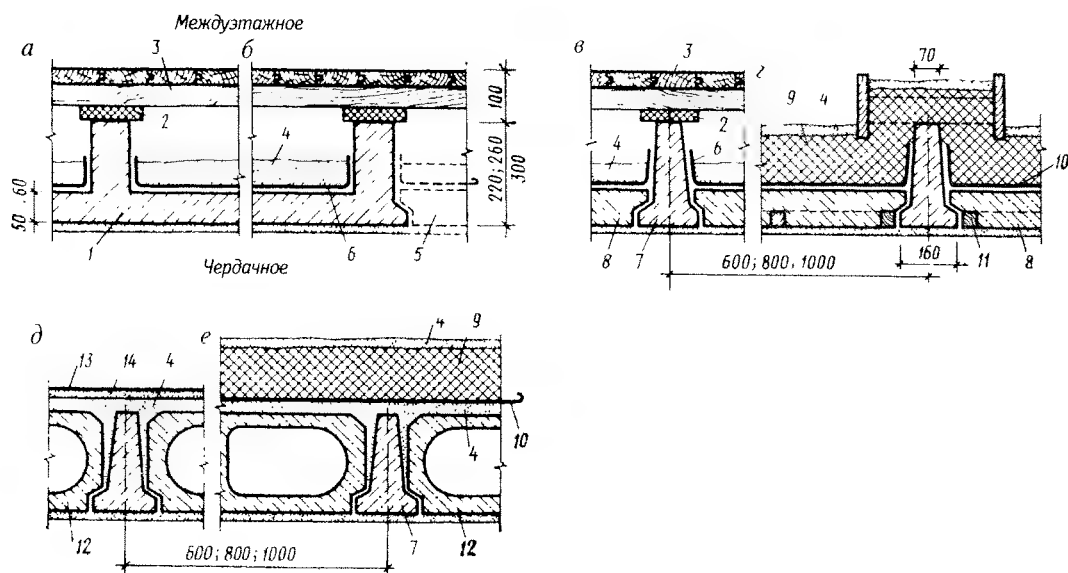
Перекрытия монолитные и сборные по железобетонным балкам: а, б – монолитные; в, г – сборные по железобетонным балкам с гипсовыми плитами; д, е – то же, с легковесными вкладышами (б – узел сопряжения монолитного участка со сборным перекрытием по железобетонным балкам; д – пример устройства пола из линолеума); 1 – монолитный железобетон; 2 – упругая прокладка; 3 – дощатый пол по лагам; 4 – песок не менее 20 мм; 5 – условно показано сборное перекрытие; 6 – толь; 7 – железобетонная тавровая балка; 8 – плита гипсовая или легковесная; 9 – утеплитель (минеральная вата и др.); 10 – пароизоляция; 11 – деревянный каркас; 12 – двухпустотный легковесный вкладыш; 13 – линолеум по прослойке из холодной мастики на водостойких вяжущих; 14 – стяжка из легкого бетона 20 мм
